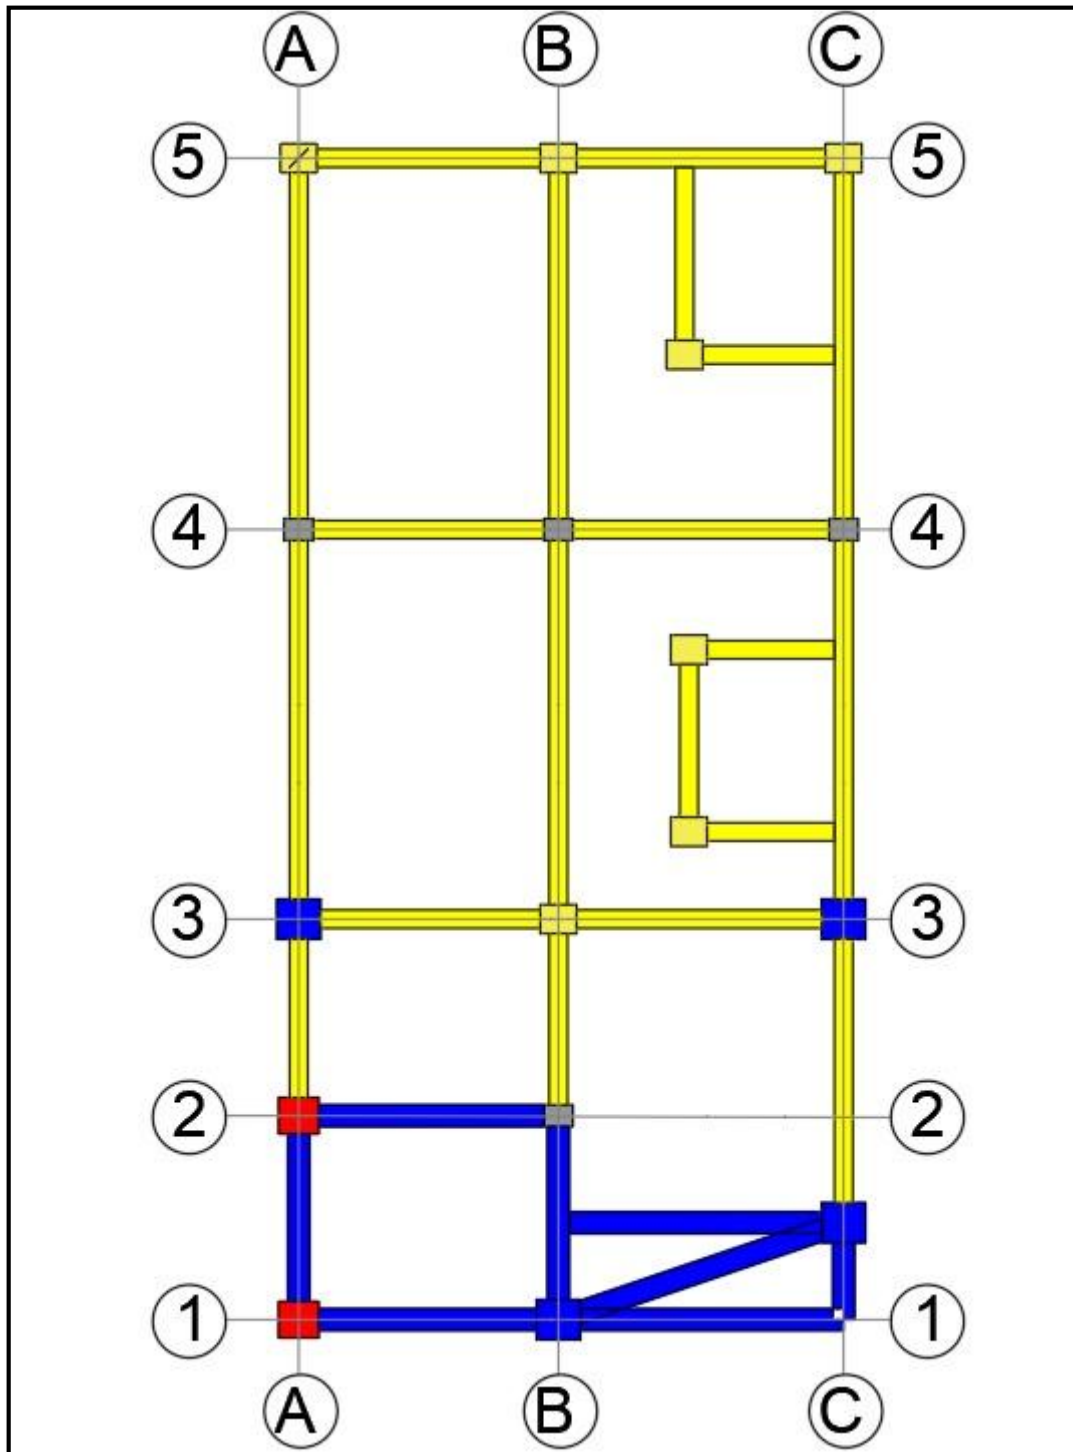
Distribución de vigas y columnas piso 5. Fuente: Nicolás Pozo
